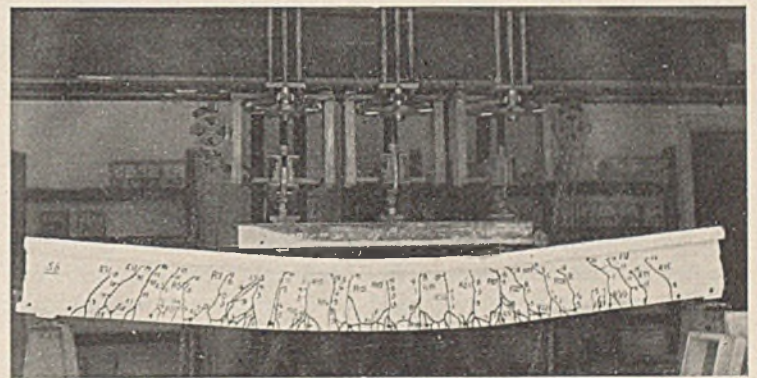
Drillwulstbalken: Stetige Biegelinie.
